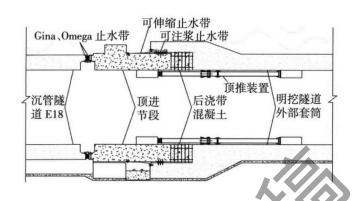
大连湾沉管隧道最终接头纵剖面构造图
